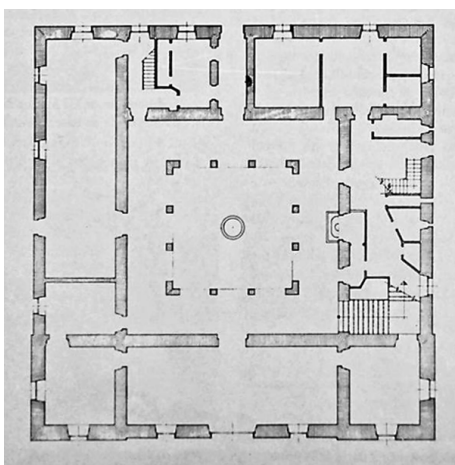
Lazcano. Palacio de Lazcano. Planta baja (Edorta KORTADI OLANO: «Palacio de Lazcano...», *op. cit.*)
